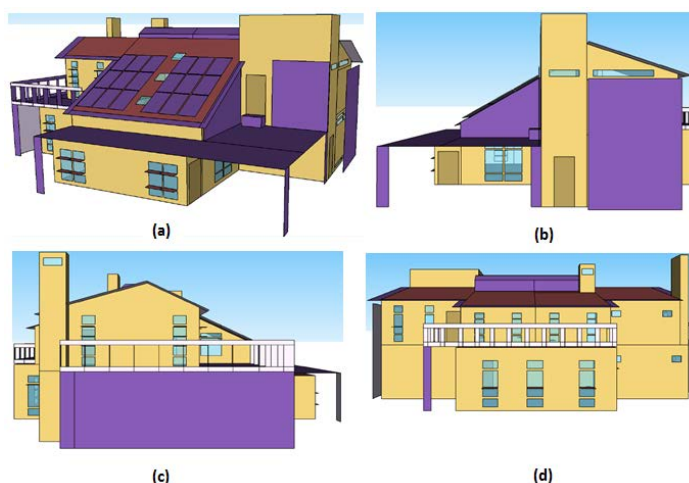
Figura I.B – Em (a), edificação em perspectiva; (b) Fachada Oeste; (c) Fachada Leste; (d) Fachada Sul
